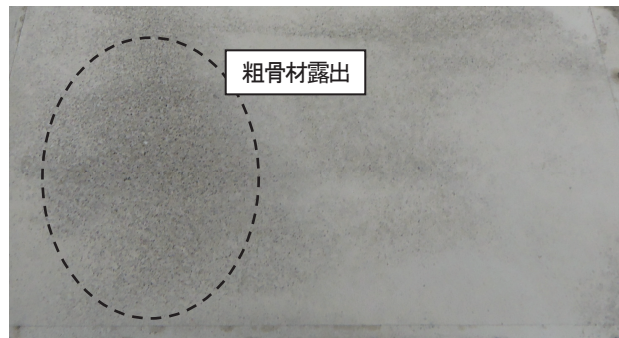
①定木均し後 15mm/h 降雨（硬化後）
